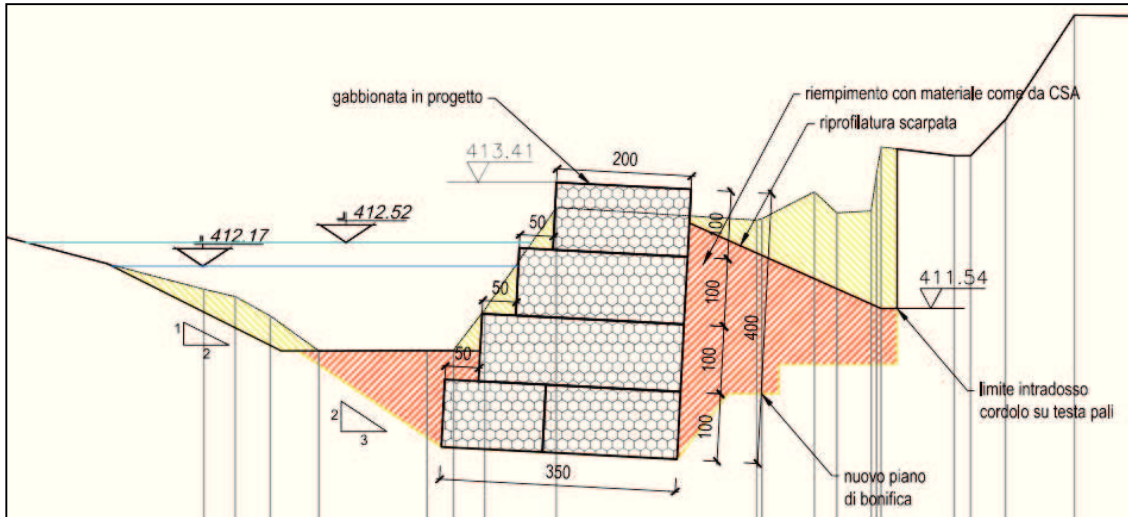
Stralcio intervento di difesa sponale n. 2 – gabbionata in progetto, sezione trasversale.
